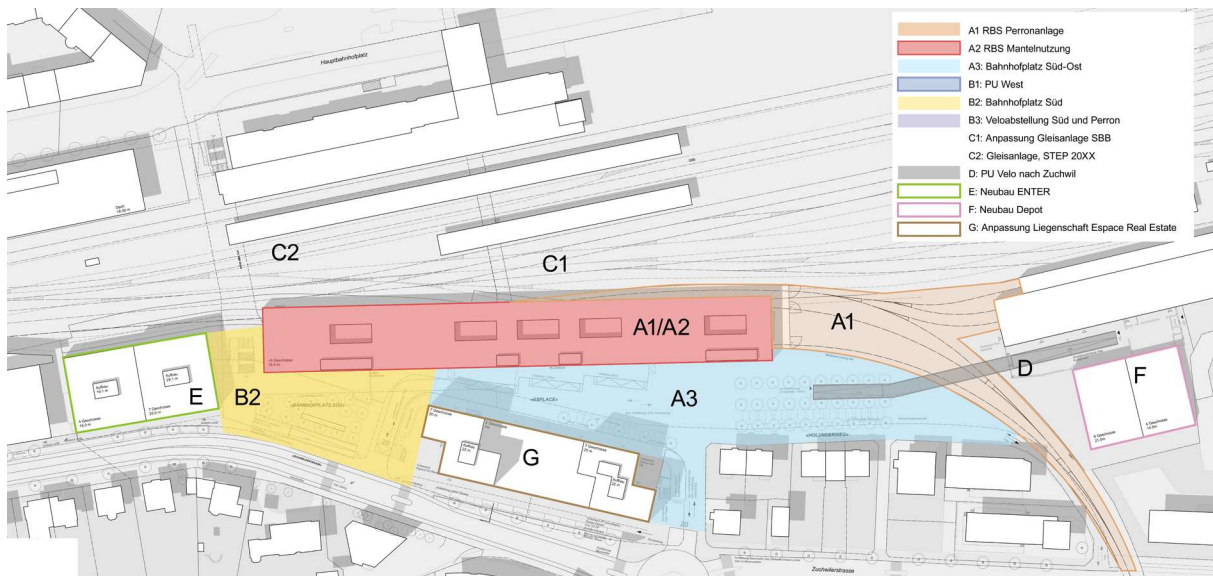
Perimeter Masterplan Ebene Erdgeschoss mit Darstellung der Module
